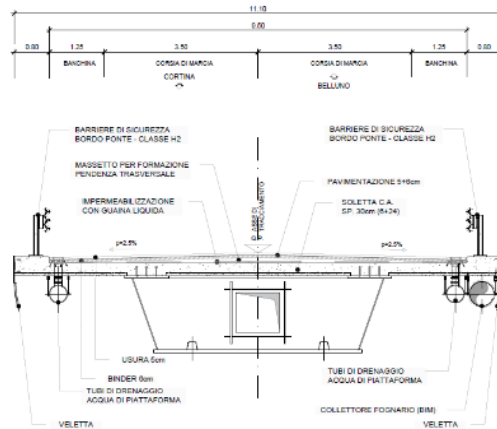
Asse Principale - Sezione tipo viadotto Ru Sec
